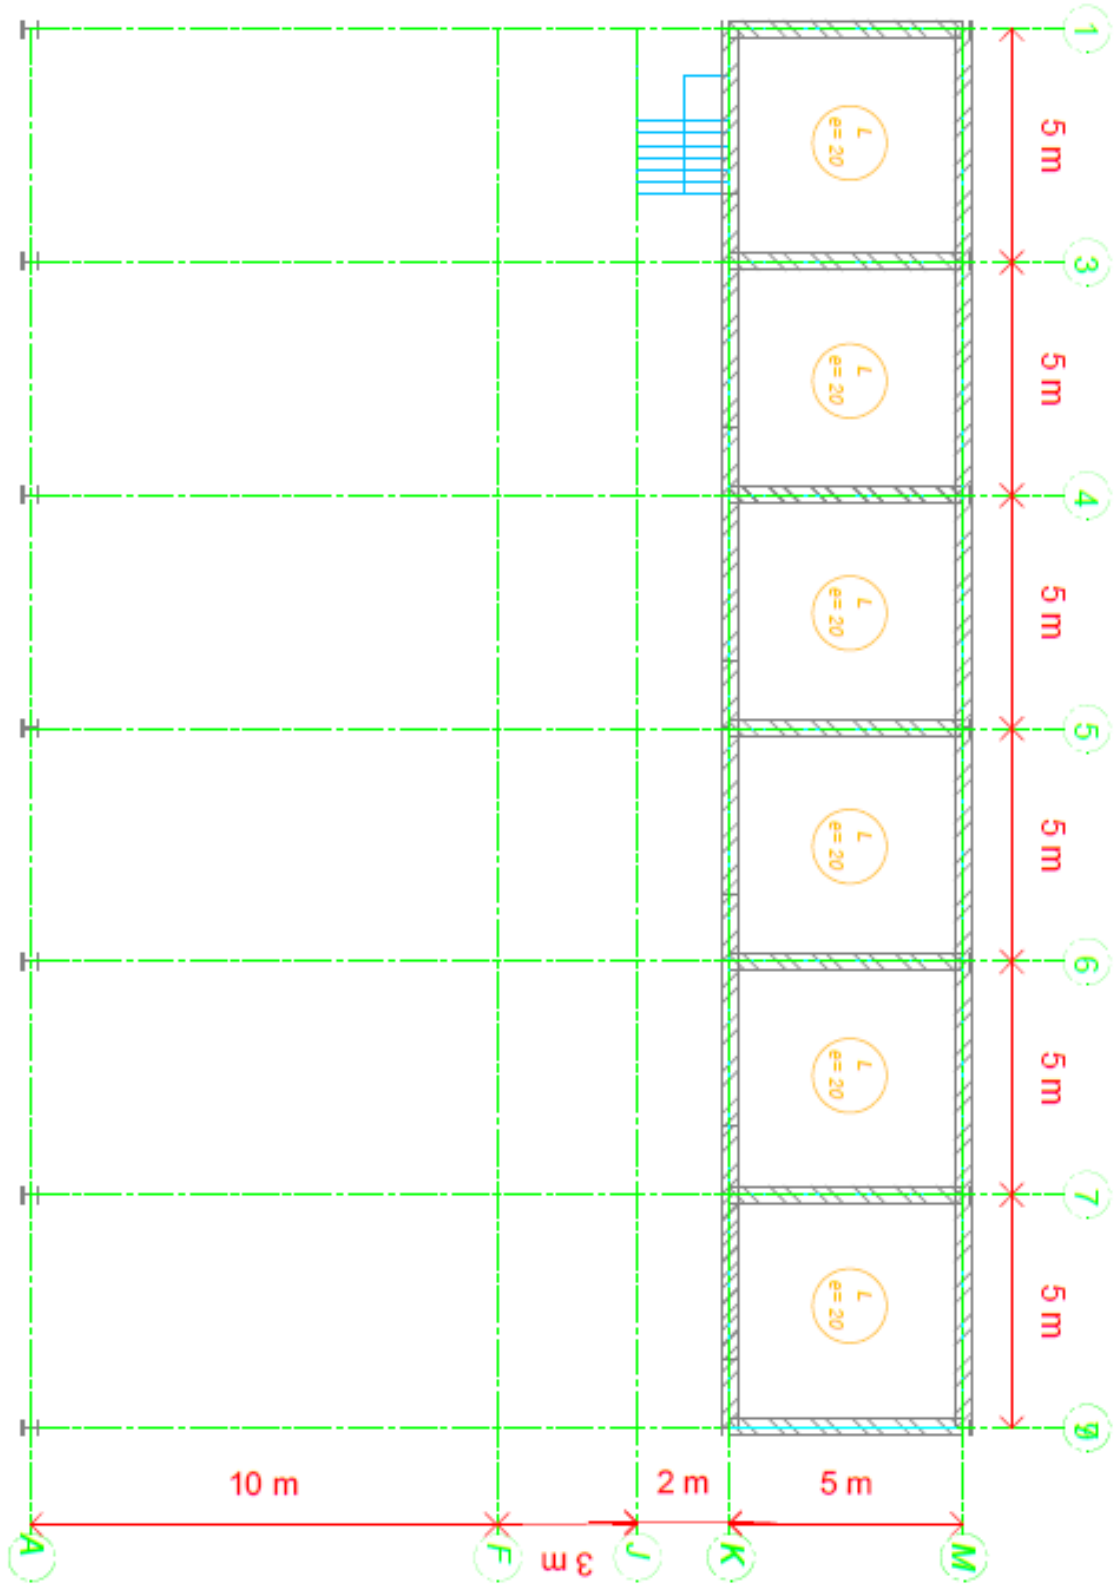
Planta estructura de acero segundo nivel N.+ 2,5 [m].
